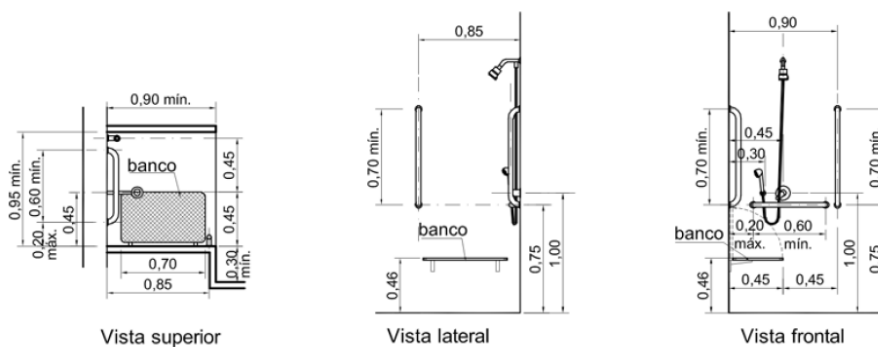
Boxe para chuveiro com barras vertical e horizontal.
